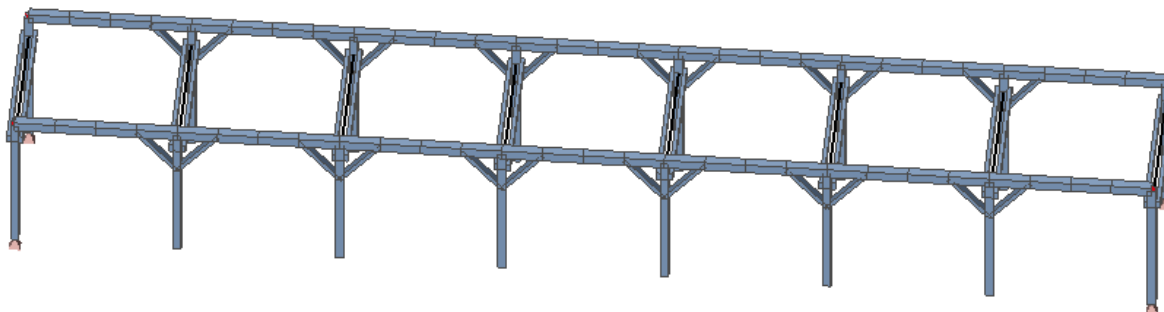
vnitřní nosná konstrukce 3NP (stávající stav)
